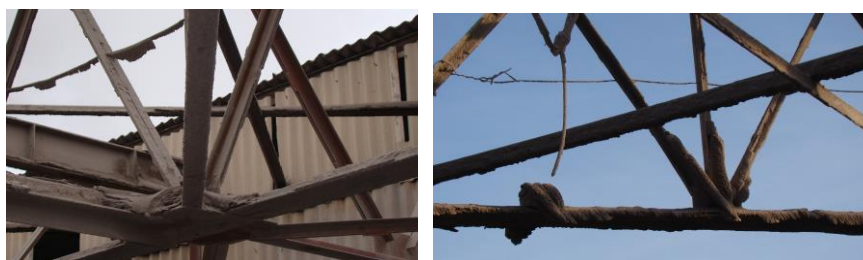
Скопление затвердевшей промышленной пыли на горизонтальных связях между фермами Ф1 и Ф2
